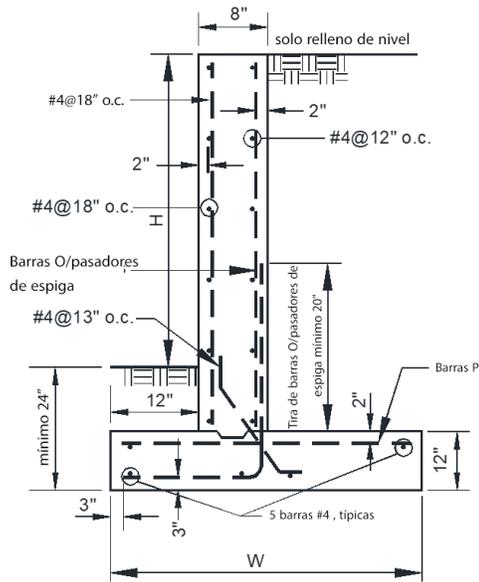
SECCIÓN TÍPICA DE MURO DE CONCRETO
